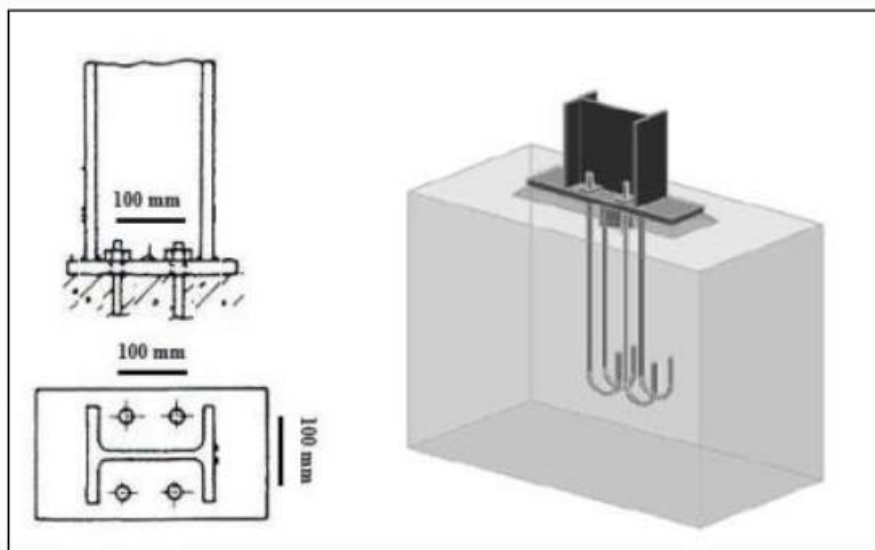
Pied de poteau articulé avec 4 boulons d'ancrage.
